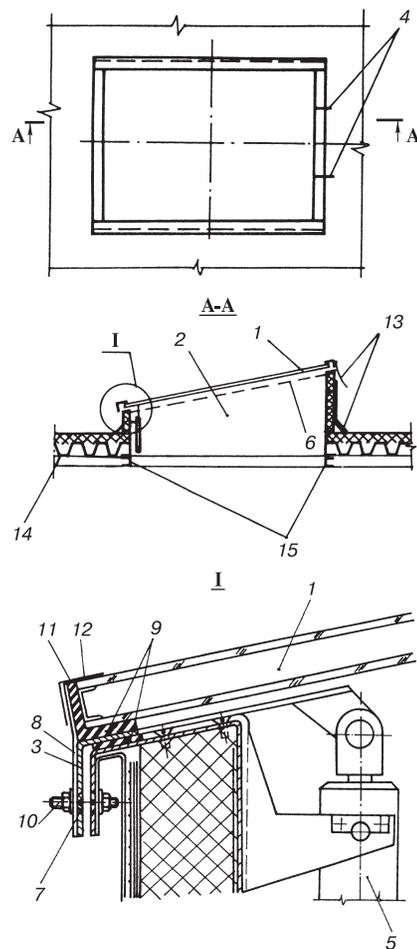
Открывающийся зенитный фонарь со светопропускающим элементом из стеклопакетов: 1 – стеклопакет; 2 – опорный утепленный контур; 3 – открывающаяся рама; 4 – петли; 5 – механизм открывания; 6 – защитная сетка; 7 – упор; 8 – прижимной элемент; 9 – резиновая прокладка; 10 – болт; 11 – алюминиевая фольга; 12 – герметик; 13 – фартук; 14 – профилированный настил; 15 – прогоны фонаря.
